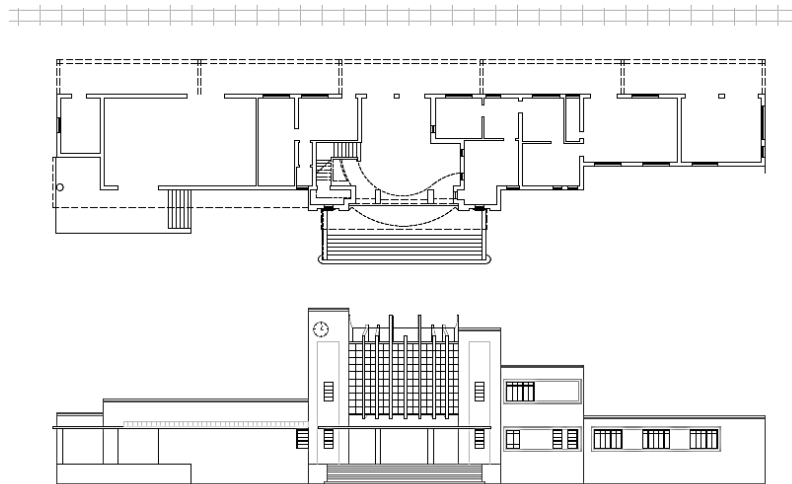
A estação na década de 1950. Planta baixa e fachada frontal
